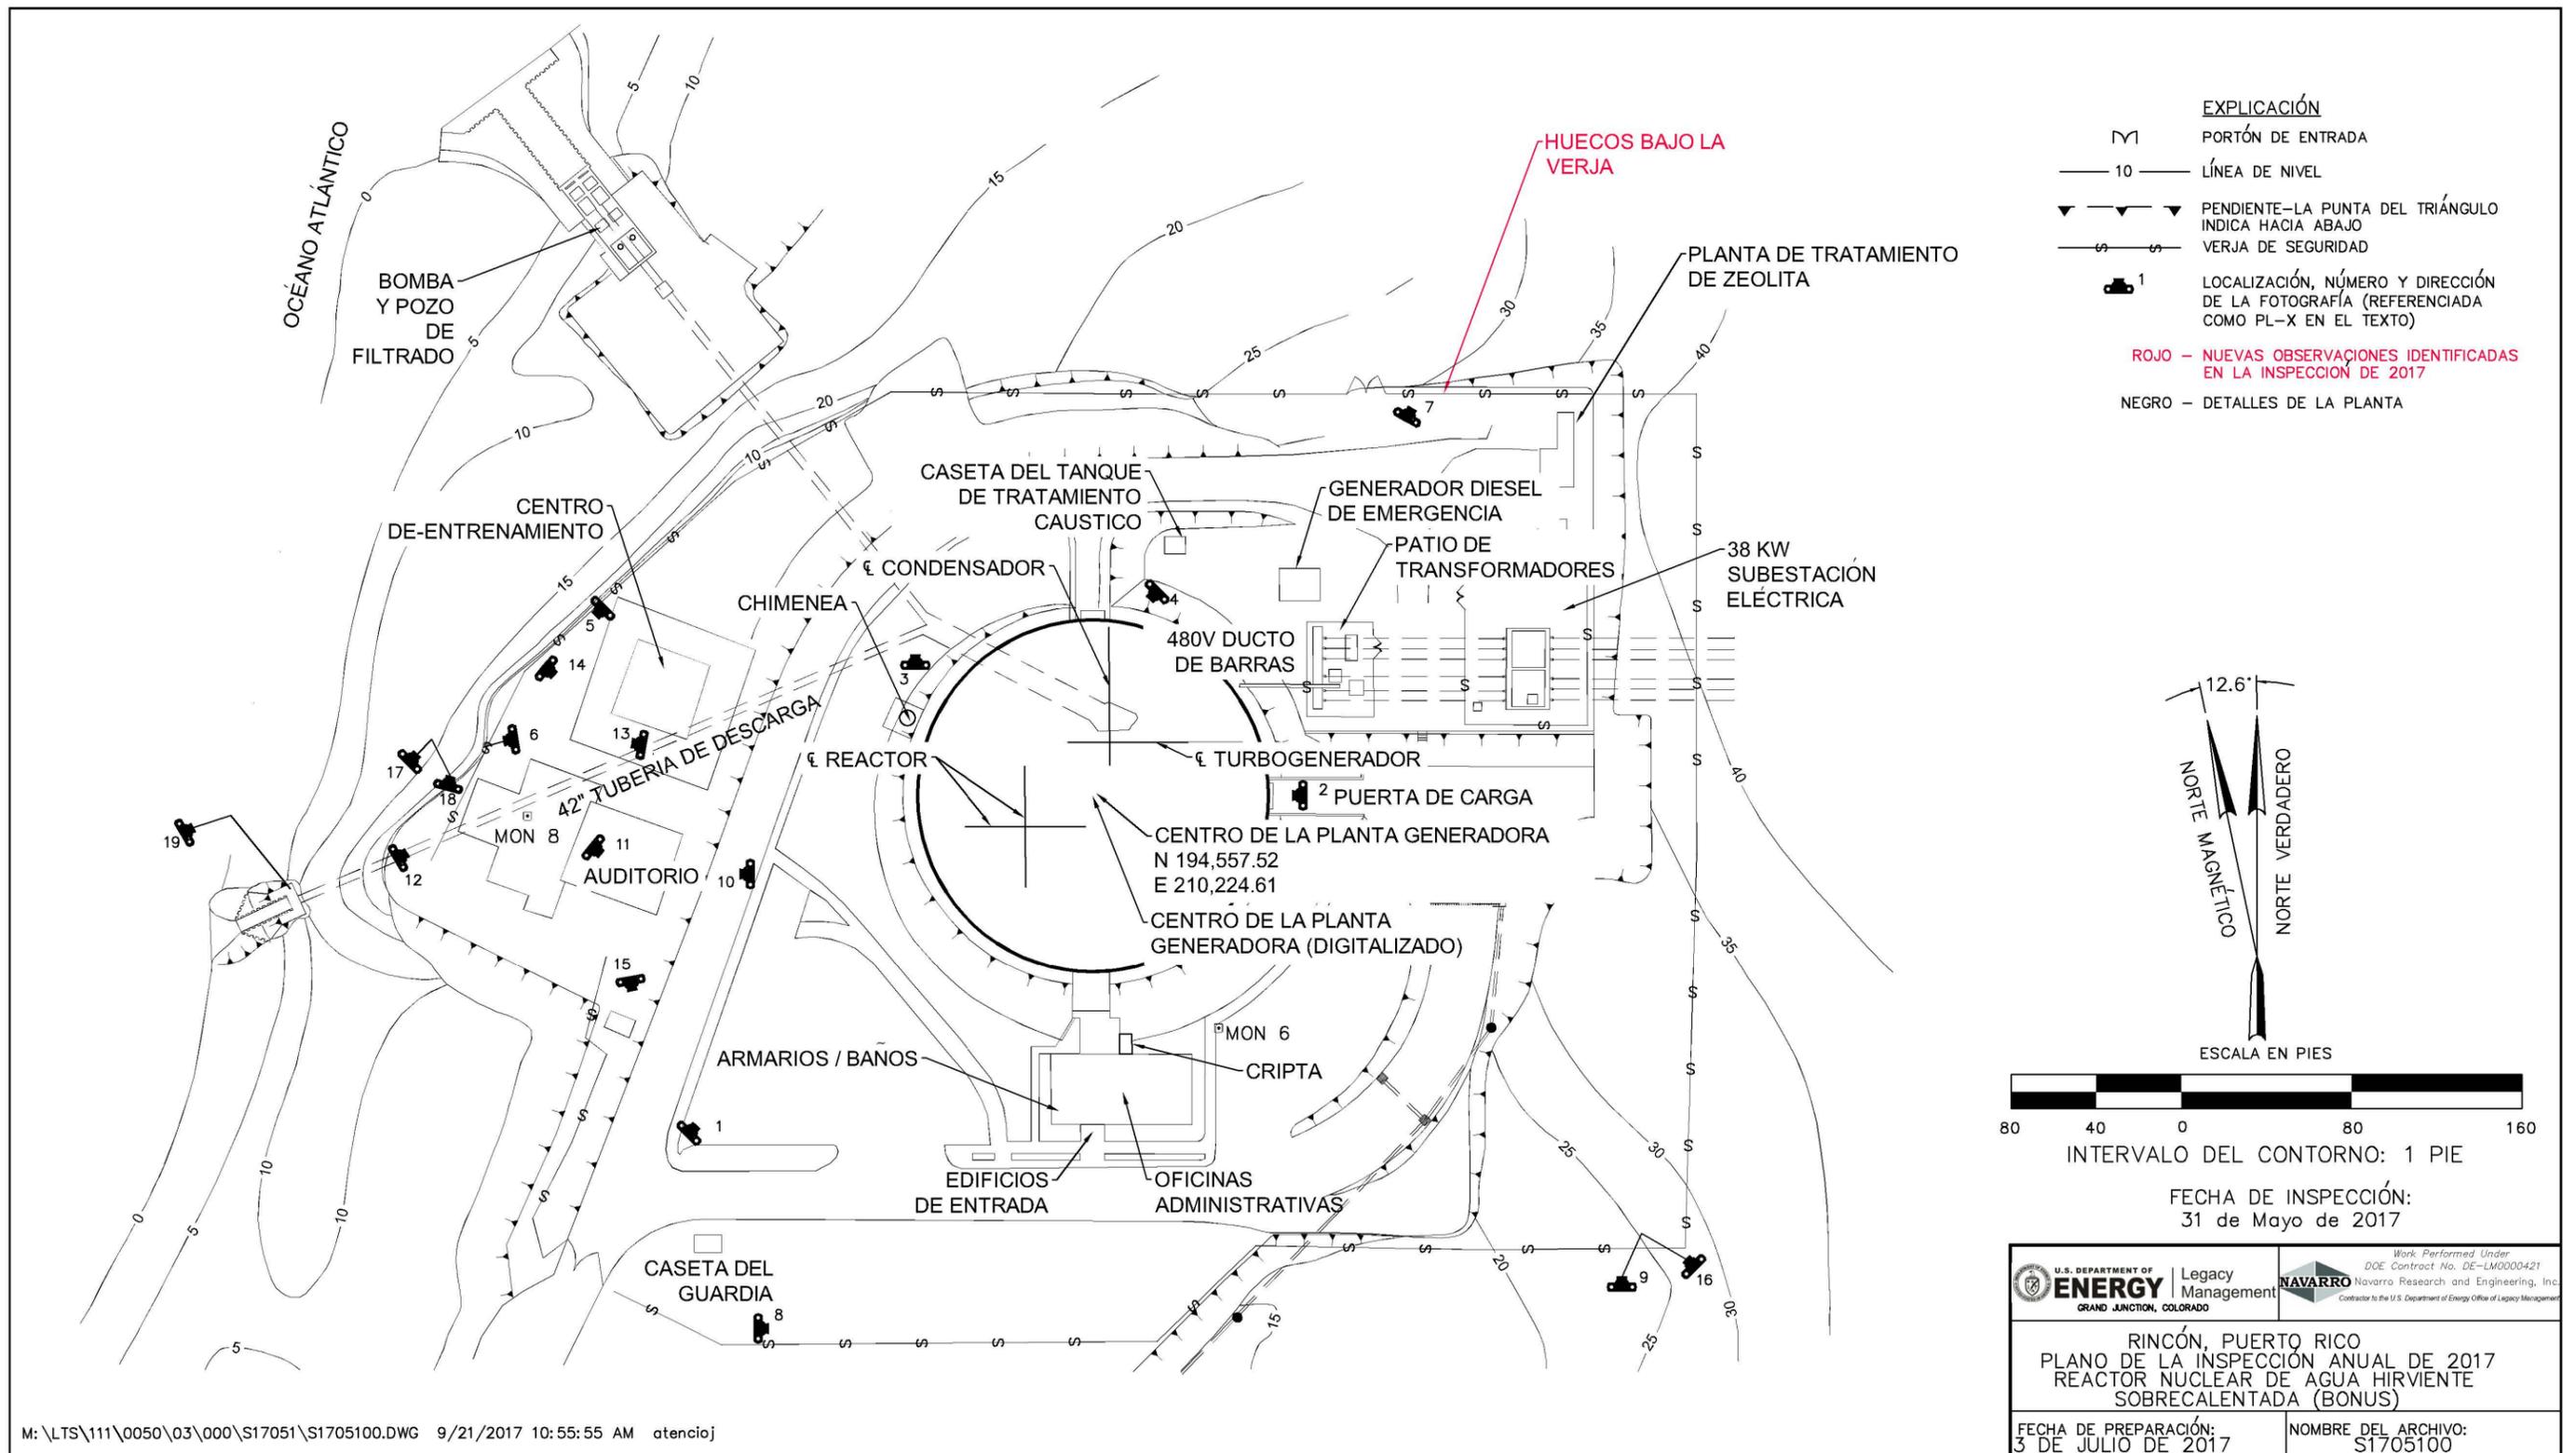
Plano de la Inspección Anual de la Planta BONUS, en Rincón, Puerto Rico
